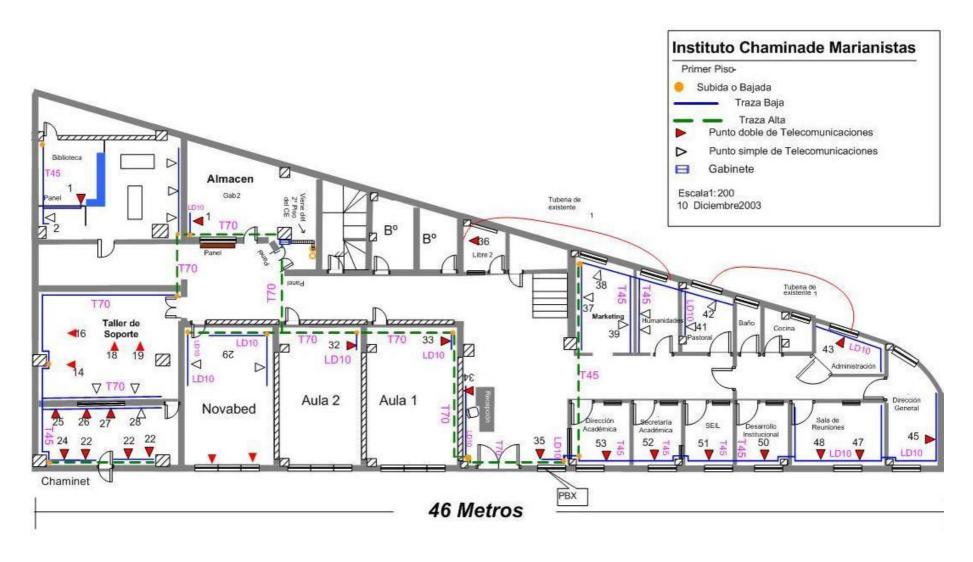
Plano del primer piso del Instituto Chaminade Marianistas
